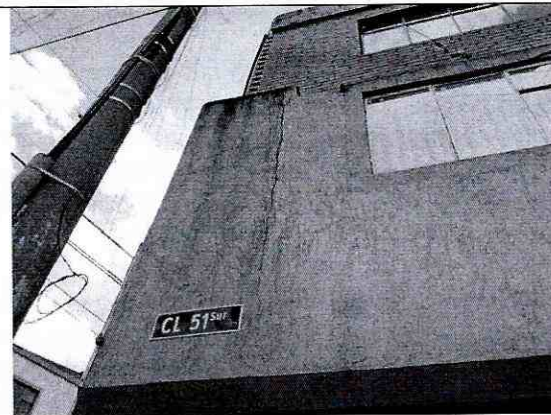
Agrietamiento en muro de fachada, segundo piso.
